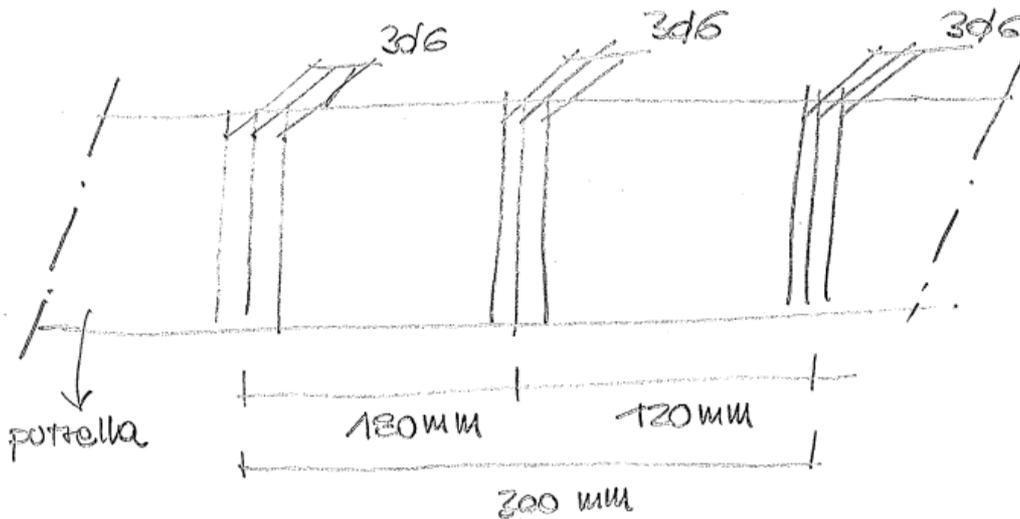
Schema della disposizione delle barre di armatura rilevate all'intradosso della putrella.
